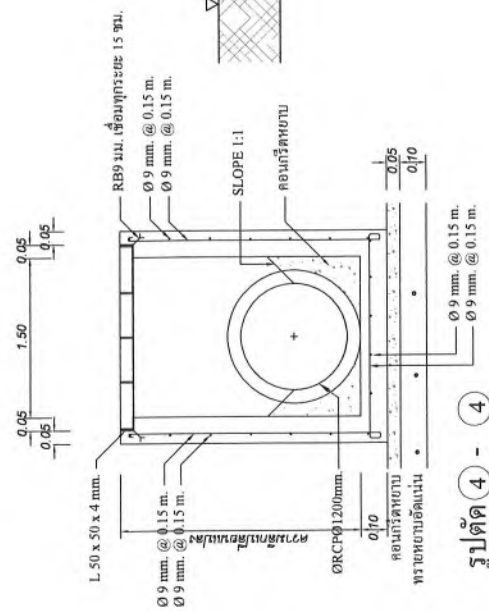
ระบบระบายน้ำของโครงการ (3)
